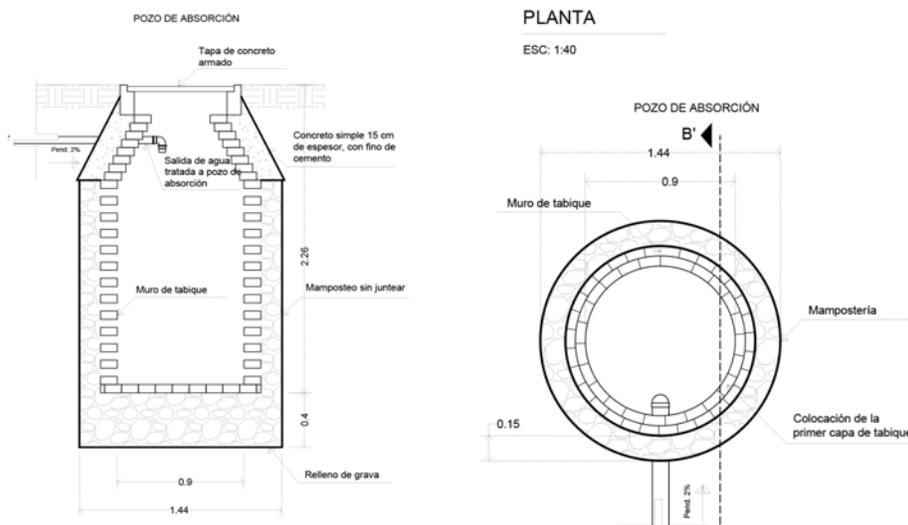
Planta y corte de pozo de absorción. Para más información ver planos IS.
